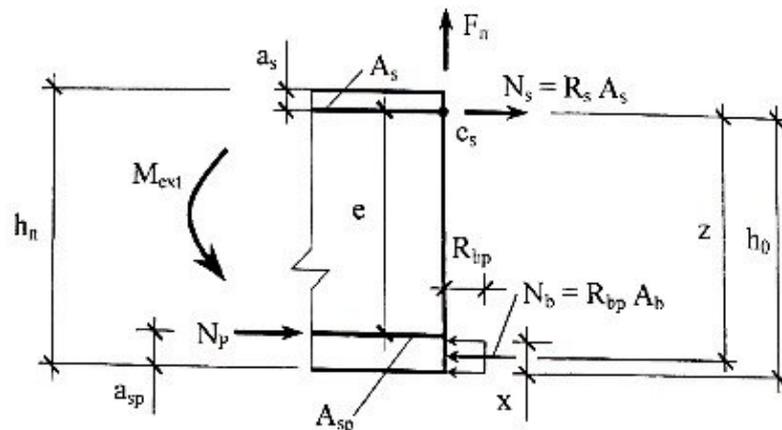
Схема внешних и внутренних усилий в расчетном сечении
